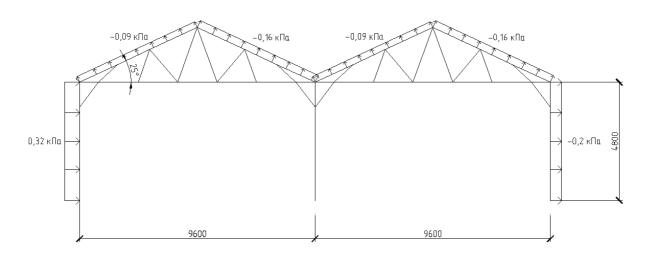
Расчетная схема для сбора ветровой нагрузки
